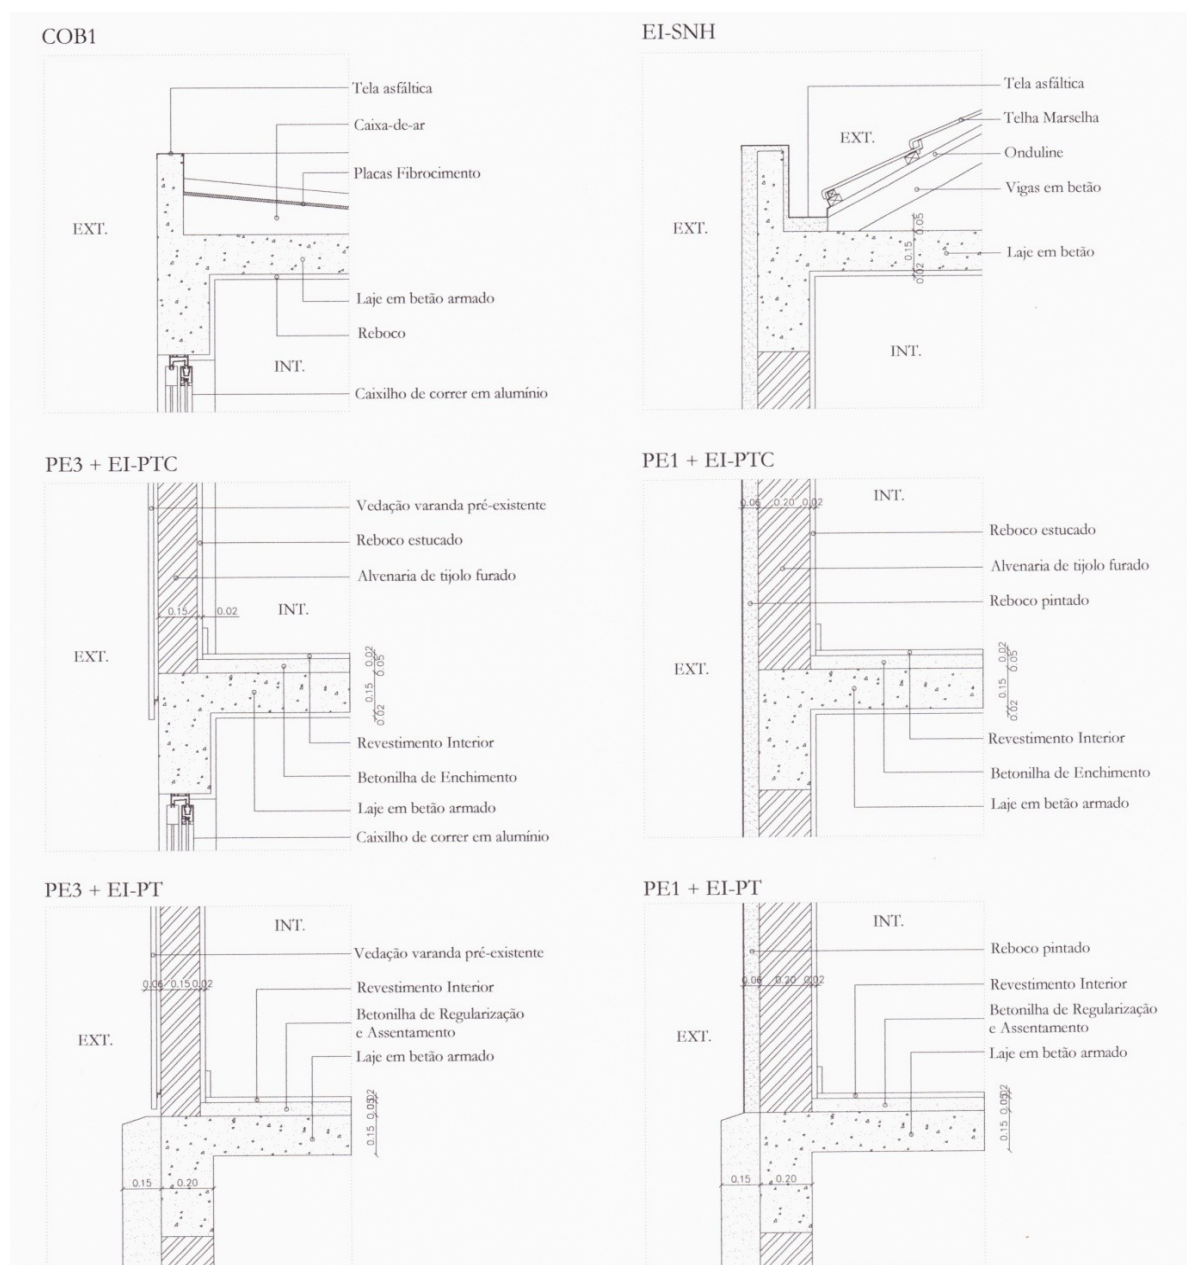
Cortes de fachada do edifício de estudo: situação existente
